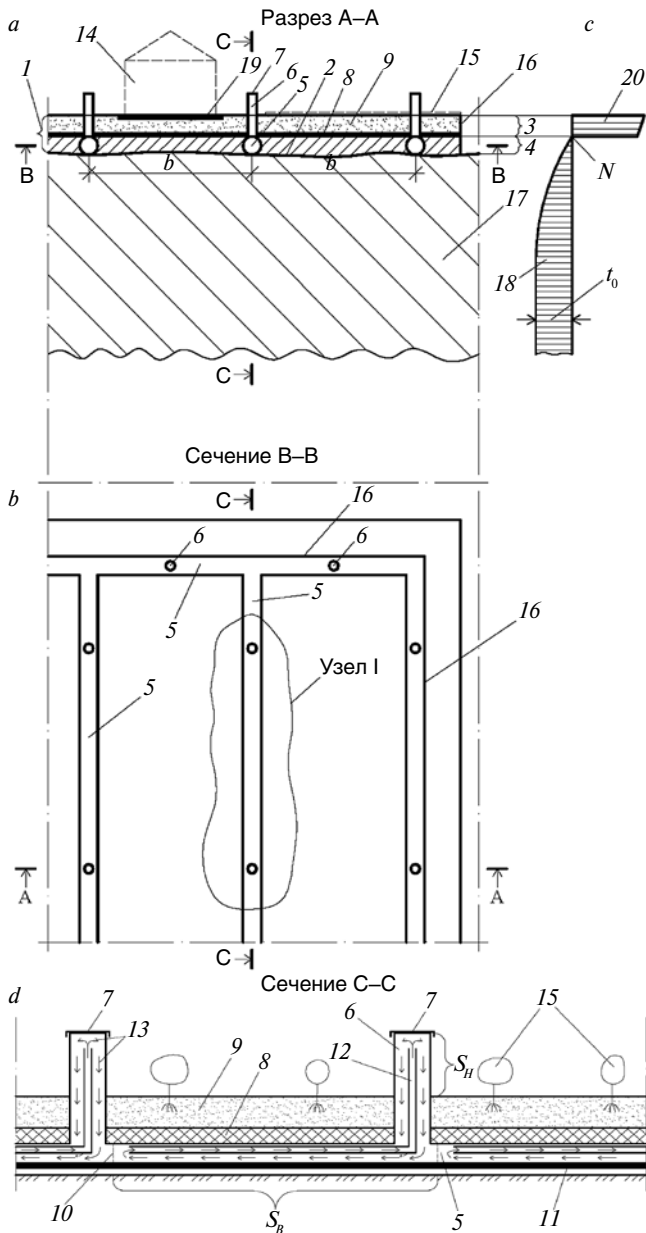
Схема площадки под строительный комплекс на вечной мерзлоте для зданий с дизайном первого типа: а – разрез А–А; б – сечение В–В; в – эпюра распределения температуры грунта по глубине в летний период; д – сечение С–С; 1 – насыщенный планировочный слой; 2 – естественная поверхность грунта; 3 – охлаждающий ярус; 4 – защитный ярус; 5 – горизонтальные пустотелые трубы; 6 – вертикальные пустотелые трубы (охлаждающие продухи); 7 – заглушка (крышка) охлаждающих продухов; 8 – слой теплоизоляции; 9 – слой грунта; 10 – шторы; 11 – теплотрассы; 12 – коаксиальная вставка; 13 – конвективные потоки воздуха; 14 – здание; 15 – площадки озеленения; 16 – боковые грани площадки; 17 – грунт основания; 18 – нижний участок температурной эпюры; 19 – дополнительная теплоизоляция; 20 – верхний участок температурной эпюры
